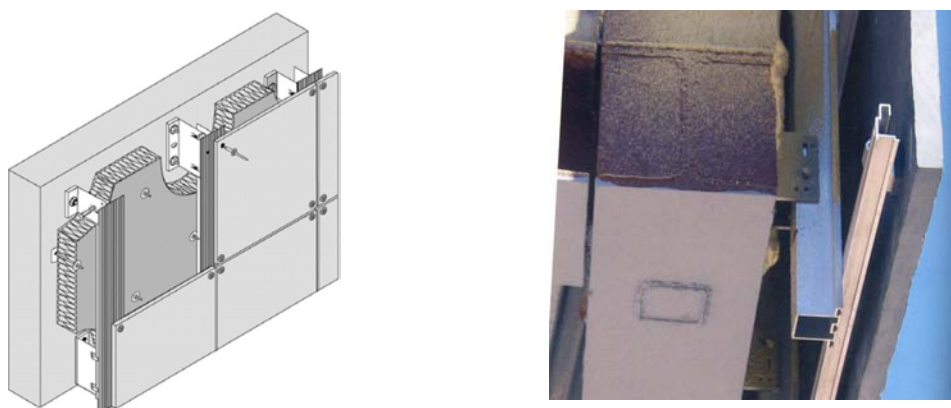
Fachada ventilada. (La fachada ventilada y ligera, Cristina Pardal / Ignacio Paricio)
